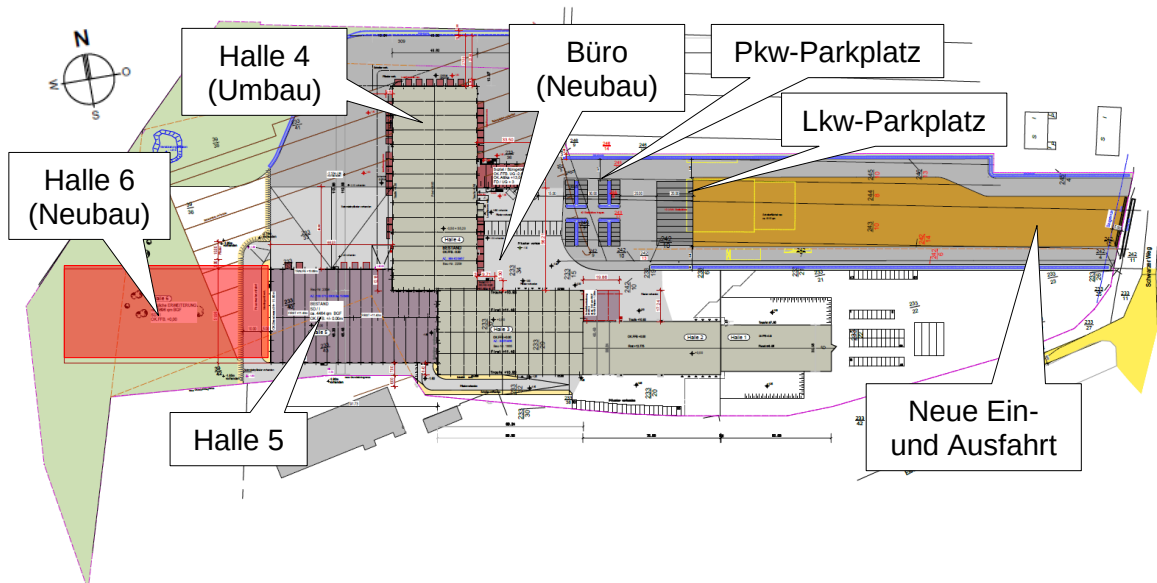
Lageplan zur Erweiterung von Krüger + Voigt, Quelle: c
